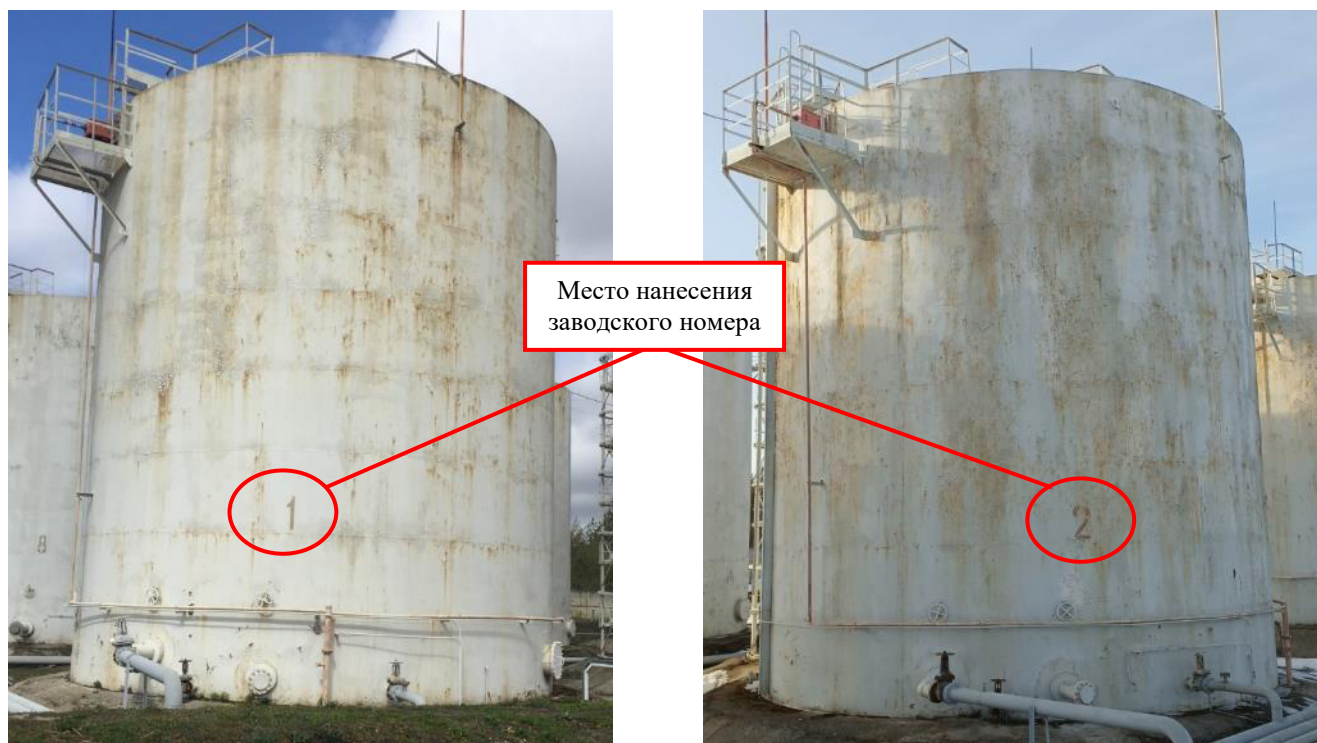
Общий вид резервуаров стальных вертикальных цилиндрических
